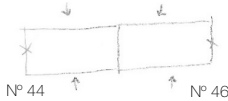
Bocetos en planta de las construcciones situadas en la Rúa Nuñez Balboa, nº 46 y 44 (autoría propia).
